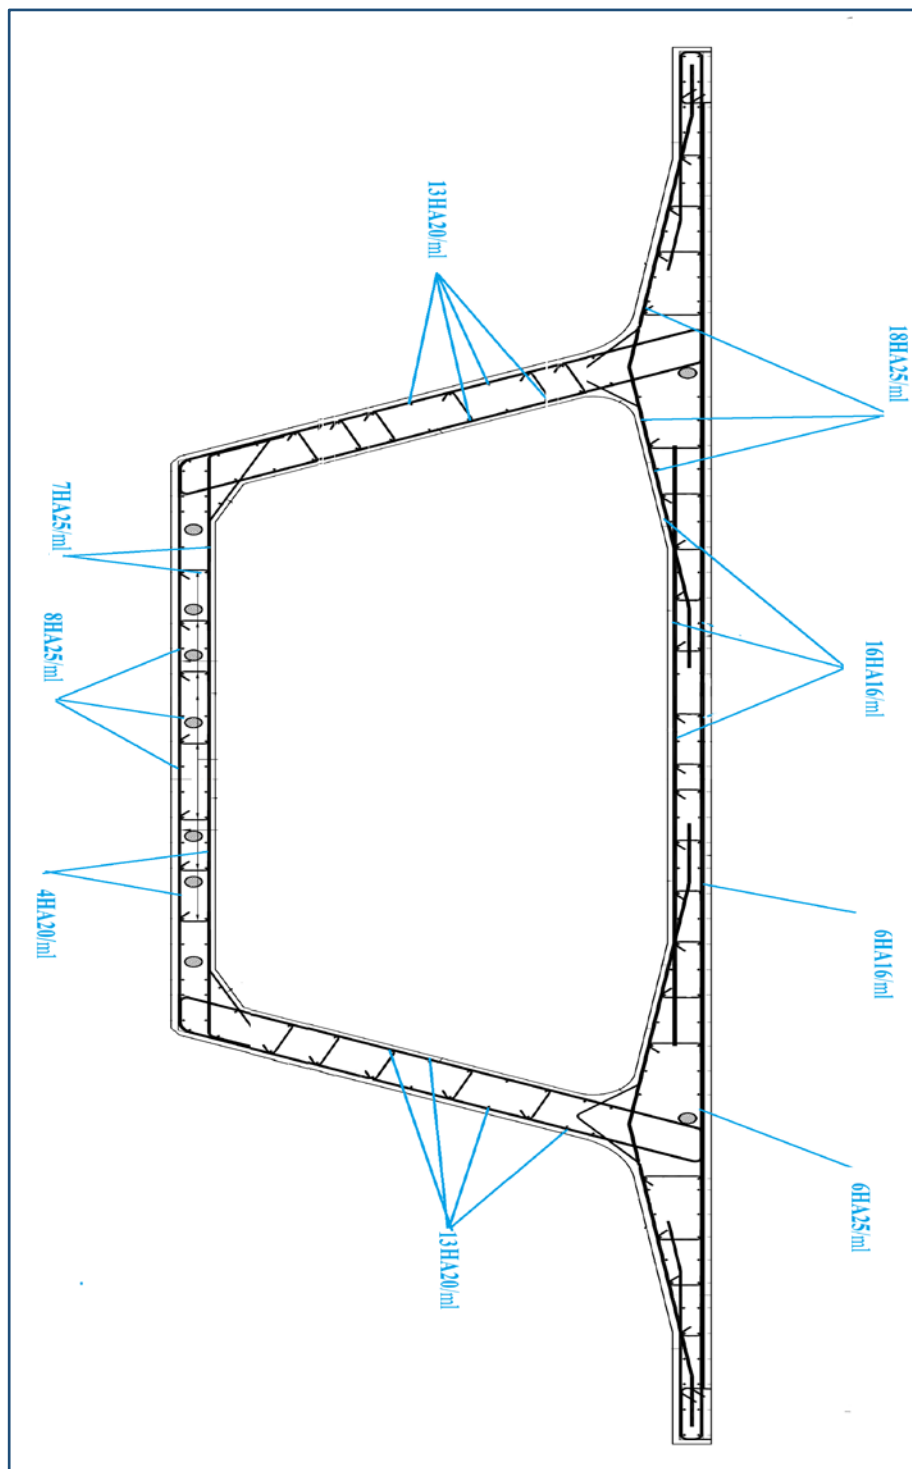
Schéma du ferrailage passif du voussoir courant.
